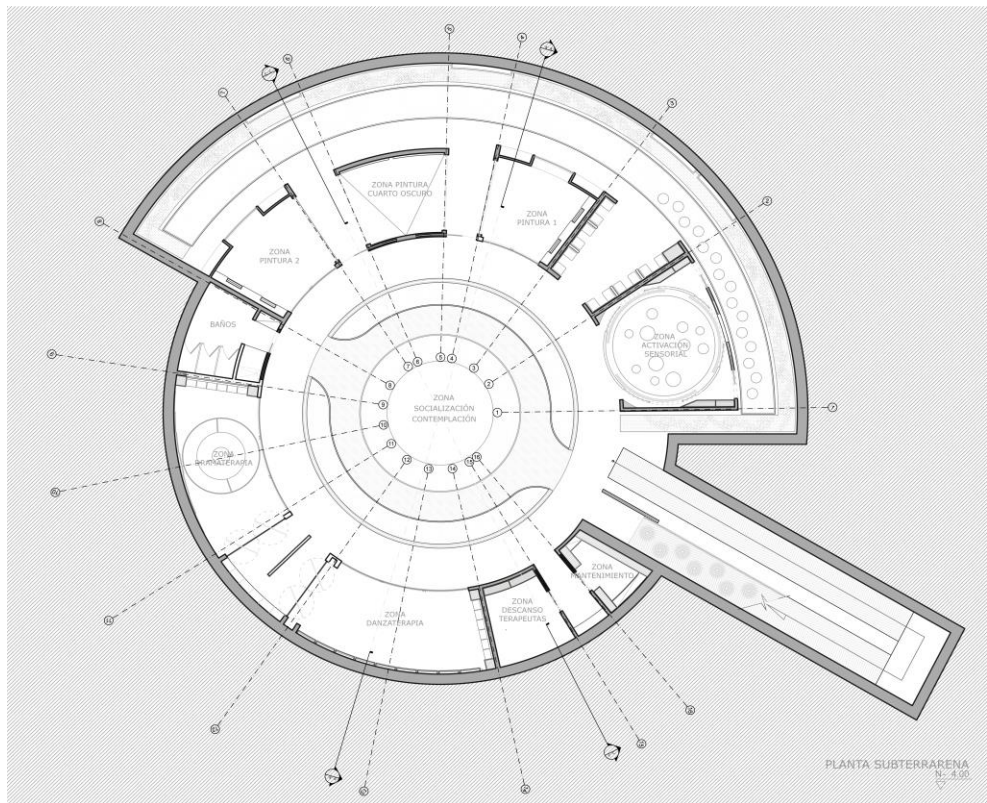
Planta Arquitectónica Subterráneo N -4.0. Esquema realizado por la autora
